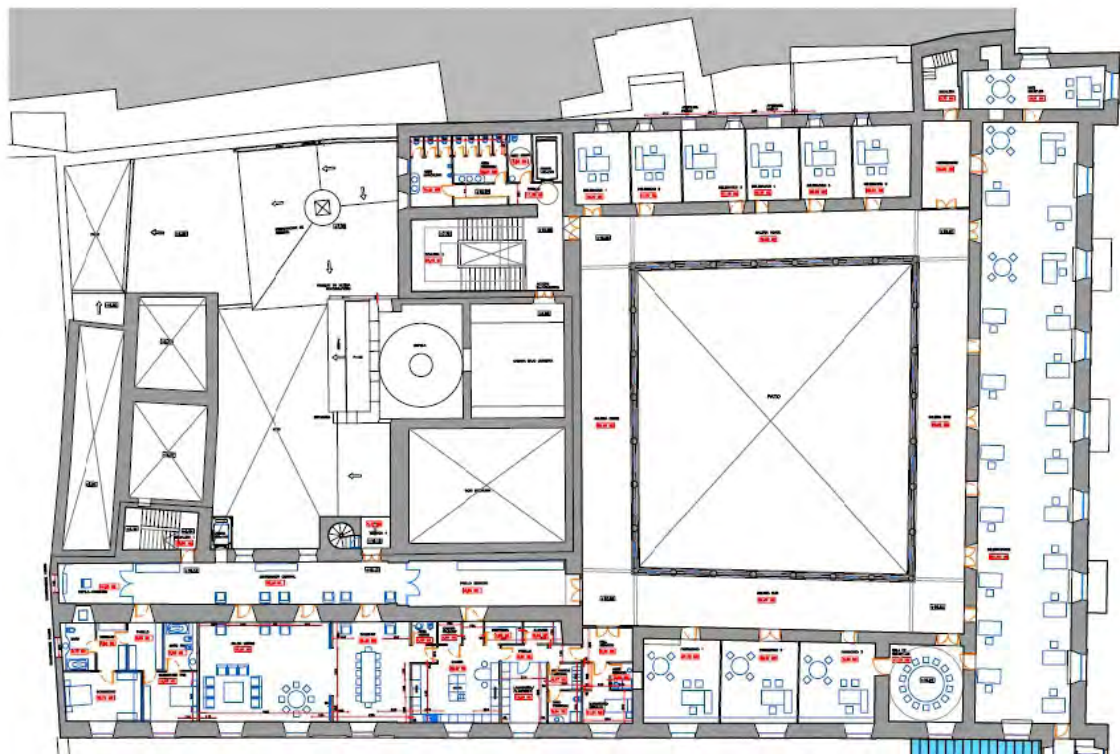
Estado reformado. Planta segunda. (OAFJ, fragmento del plano R04).
